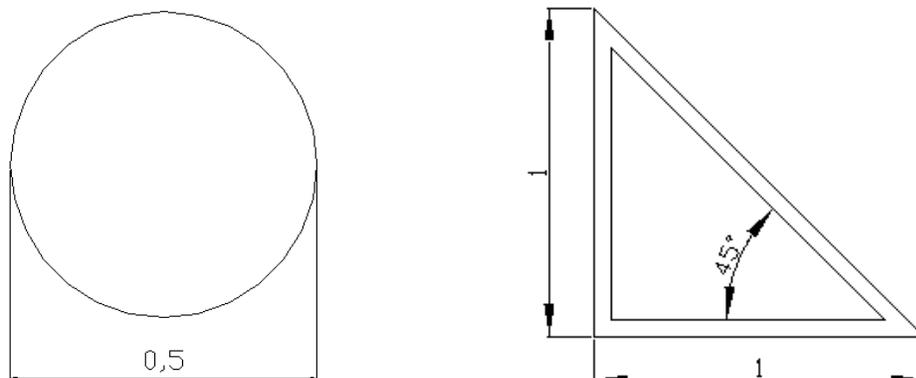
Perfil de la columna de concreto y viga de soporte del techo curvo.
